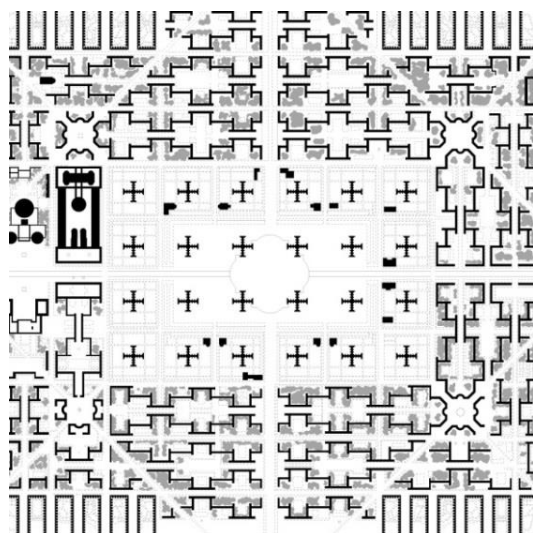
Planta geral do Plano Voisin para Paris, 1925.
